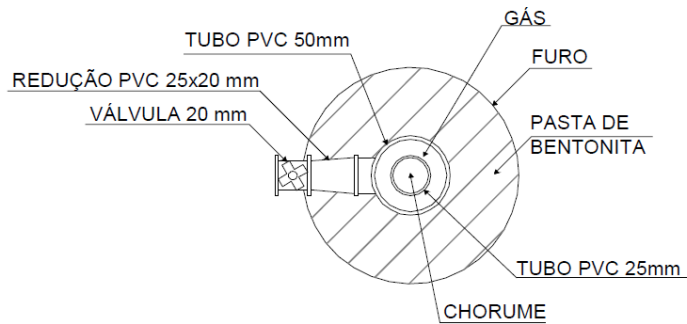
Vista superior do piezômetro sifão (Schuler, 2010).
